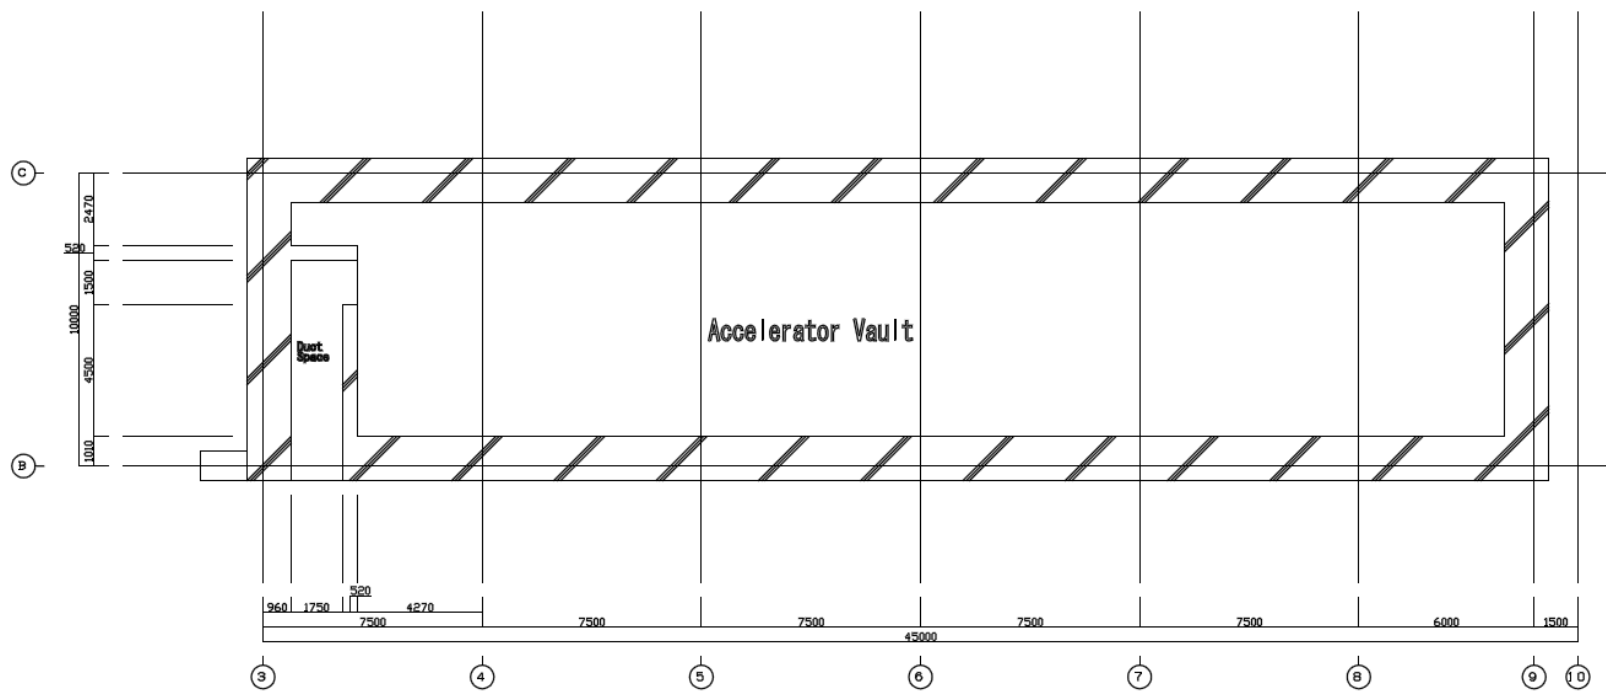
Detalle en planta de la sala del acelerador LIPAC
